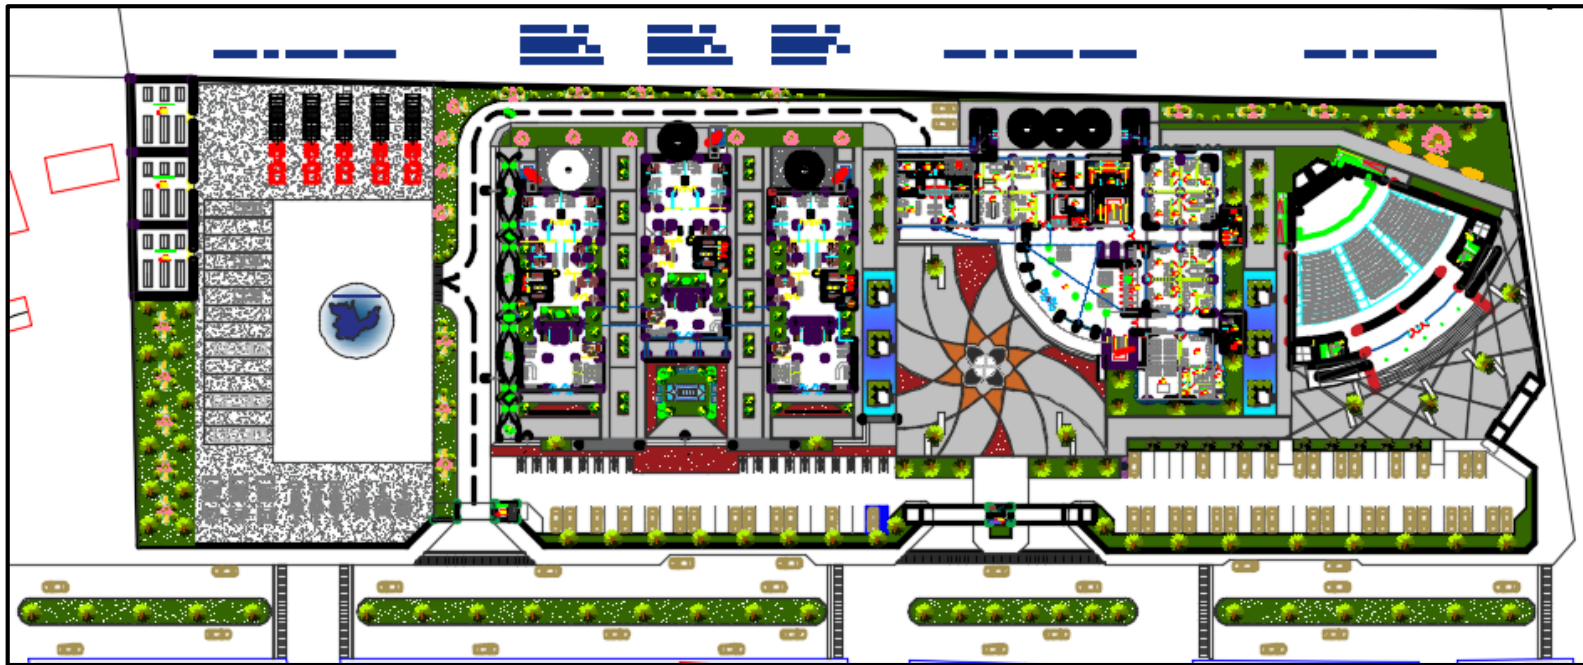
Vista de la Planta general de la propuesta arquitectónica.
